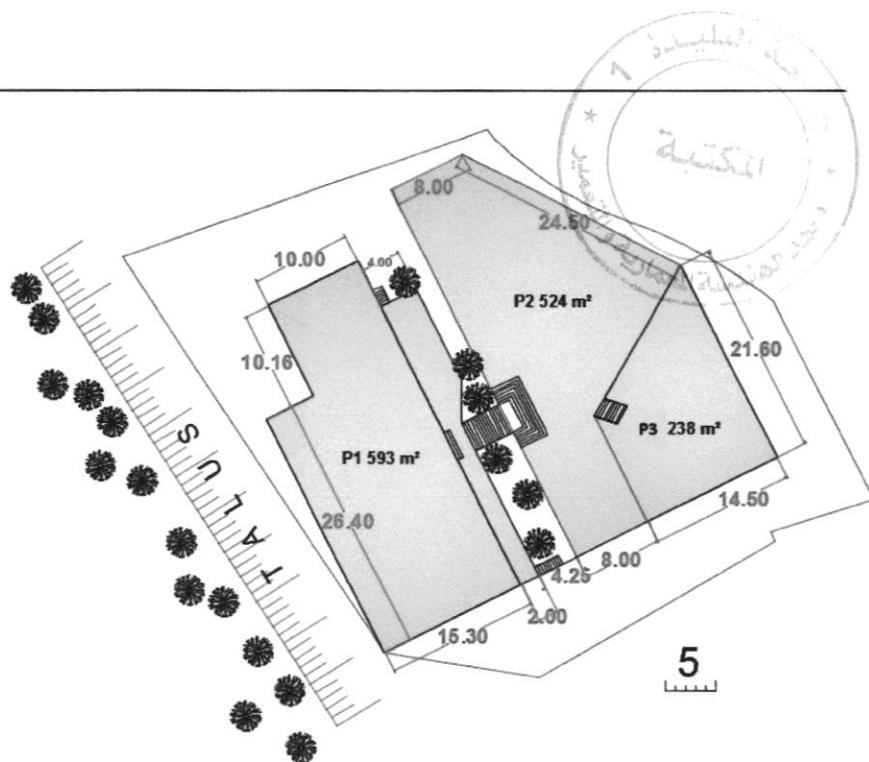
Plan schématique de dimensions du terrain/ Source : Auteur
